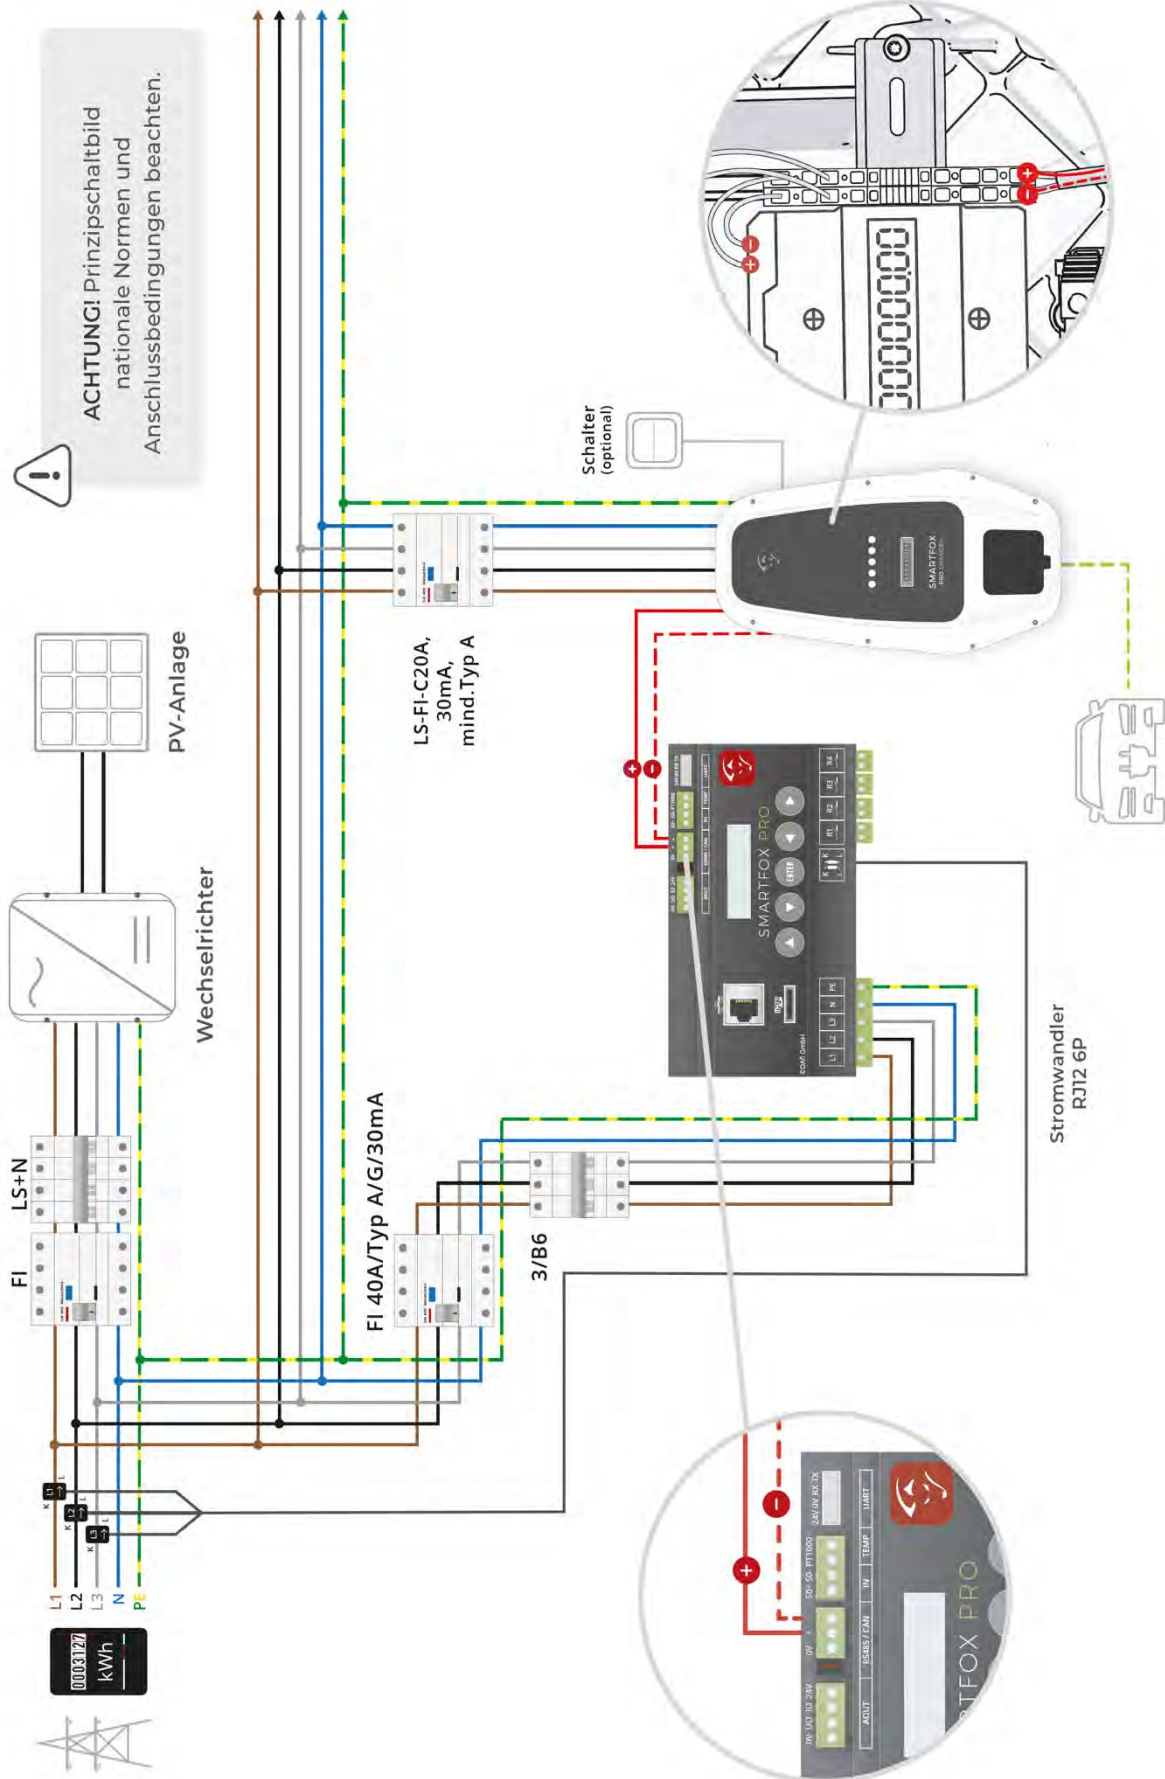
Schema di collegamento con la stazione di ricarica SF Pro - 1
